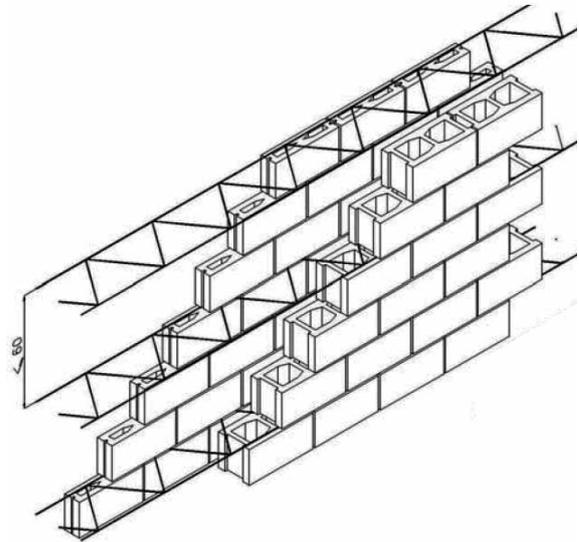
Muro capuchino de fábrica armada con armadura prefabricada de tendel de dos hojas de distinto grueso con bloque de hormigón hueco.
